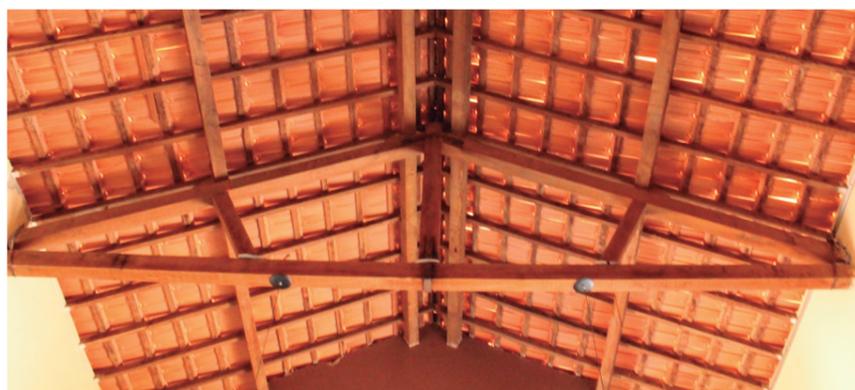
Apoio da cobertura em tesouras (Foto: Arquivo Pessoal)
